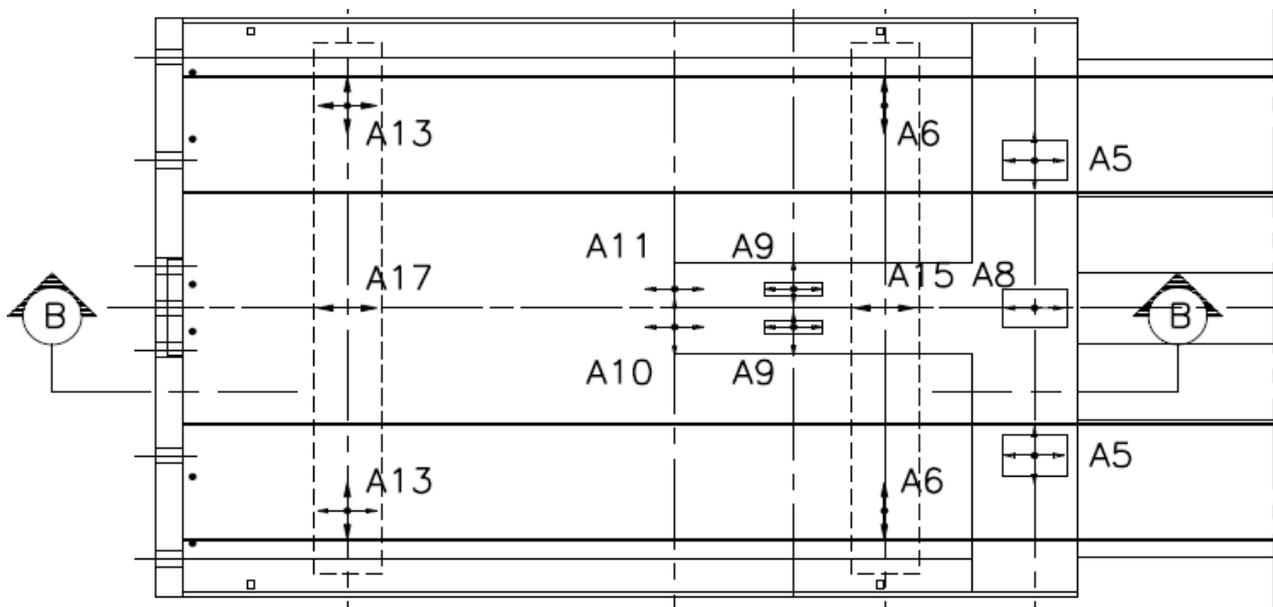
Disposizione degli appoggi alla struttura terminale lato Sicilia
